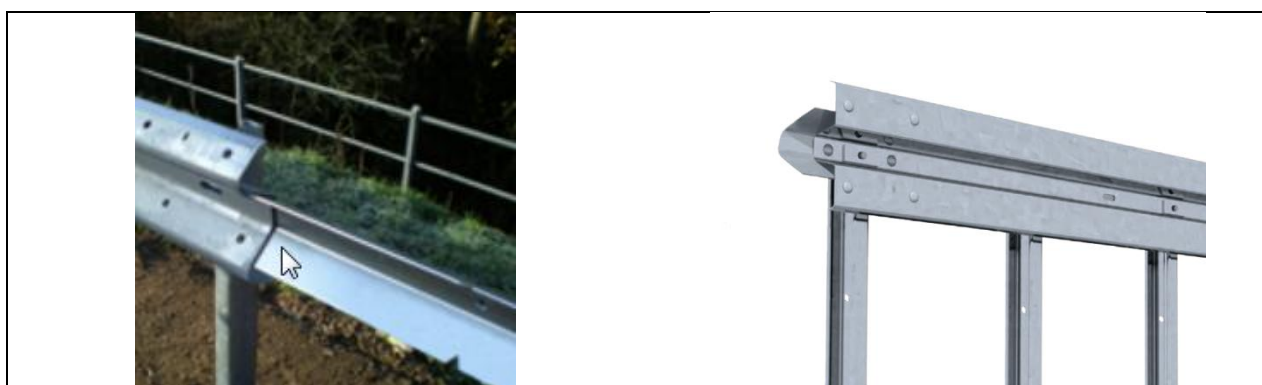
Dispositif de retenue renforcé par ajout d'un profil additionnel
